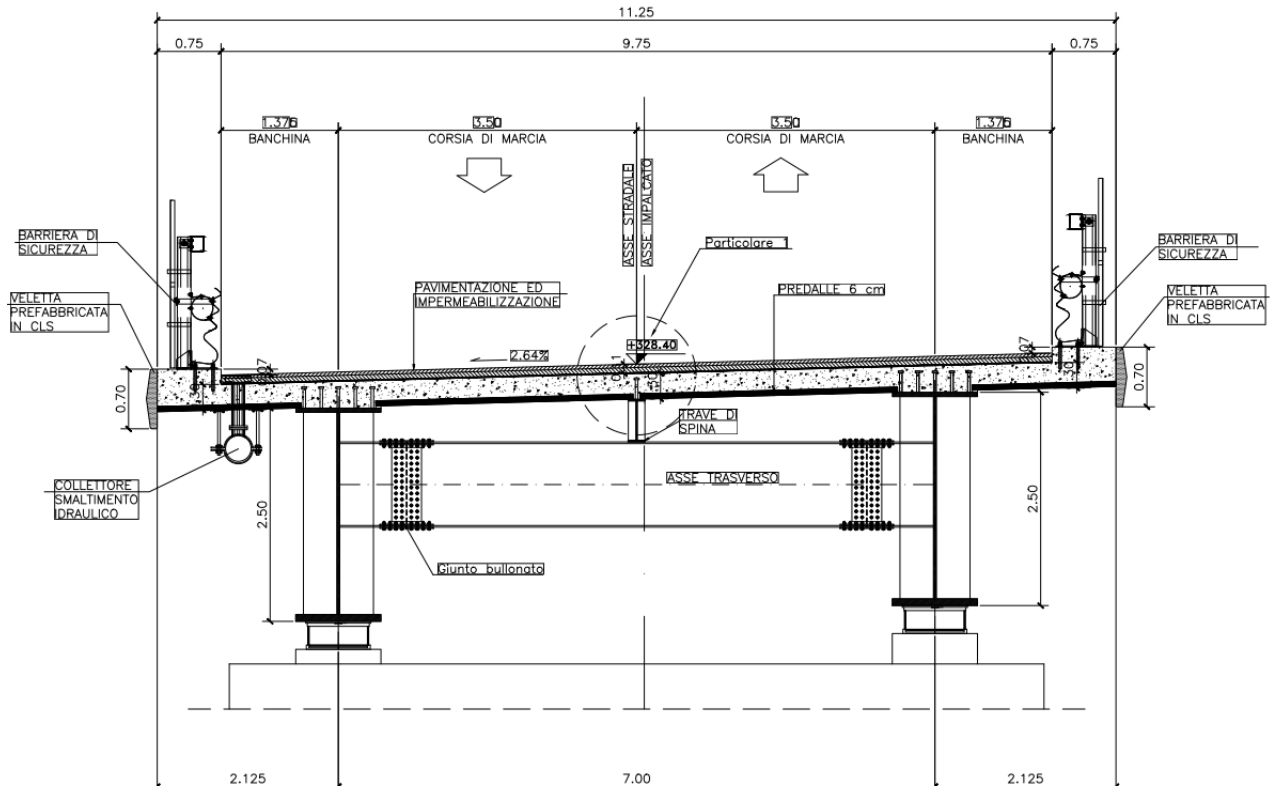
Sezione trasversale dell'impalcato - sezione tipo su pila tipo
